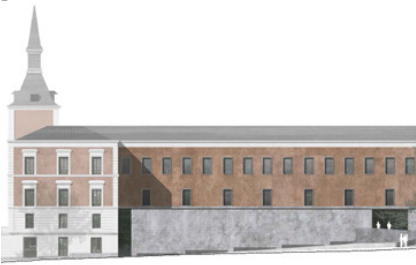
Alzado sur de la propuesta de Souto de Moura + Hernández León + De Riaño
